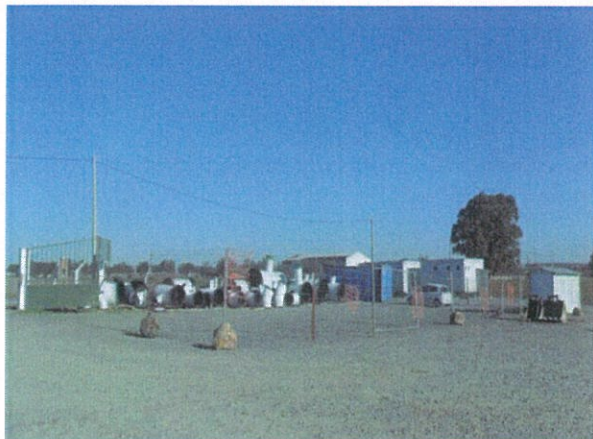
Área de Apoio à Produção: Zona de Armazenamento e Preparação de Armaduras
